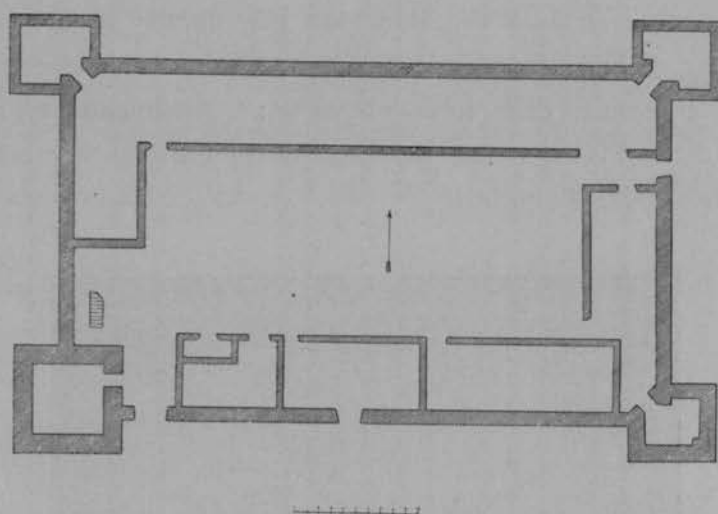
PIANTA DELLA ROCCA DI CASTELFRANCO.
